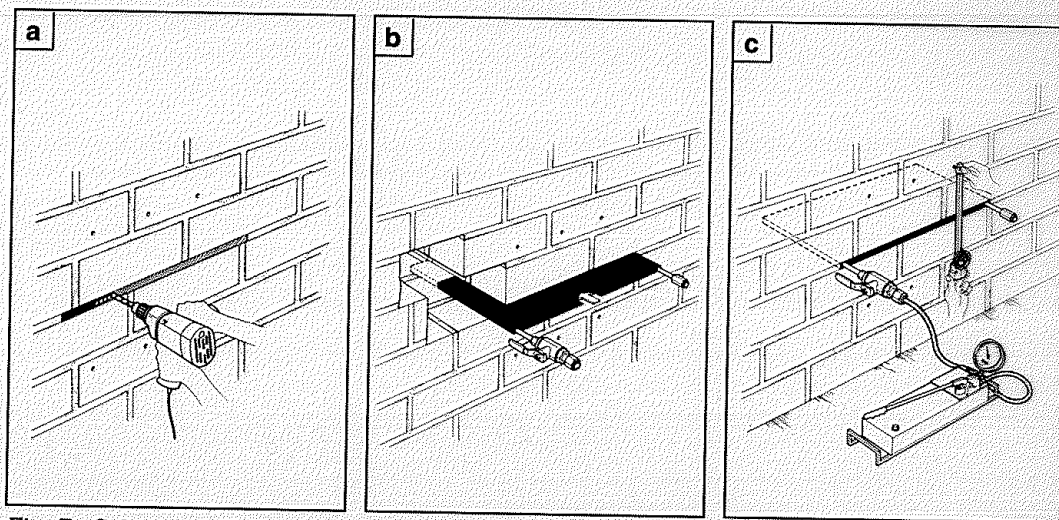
Schema delle fasi di prova con martinetto piatto per la misura dello stato di sollecitazione nelle murature in laterizio.
